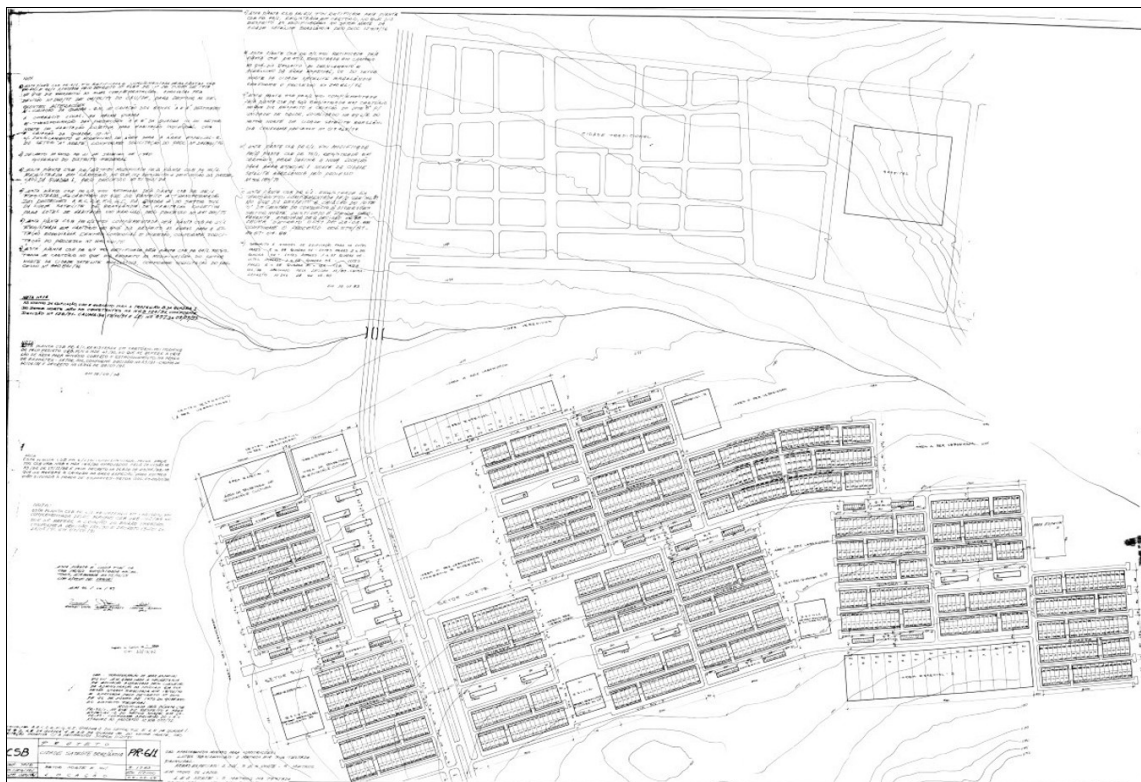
Planta do Setor - CSB PR 6/1 - objeto desta DIREQ 11/2022. Fonte: SUDEC/DIOEST.
